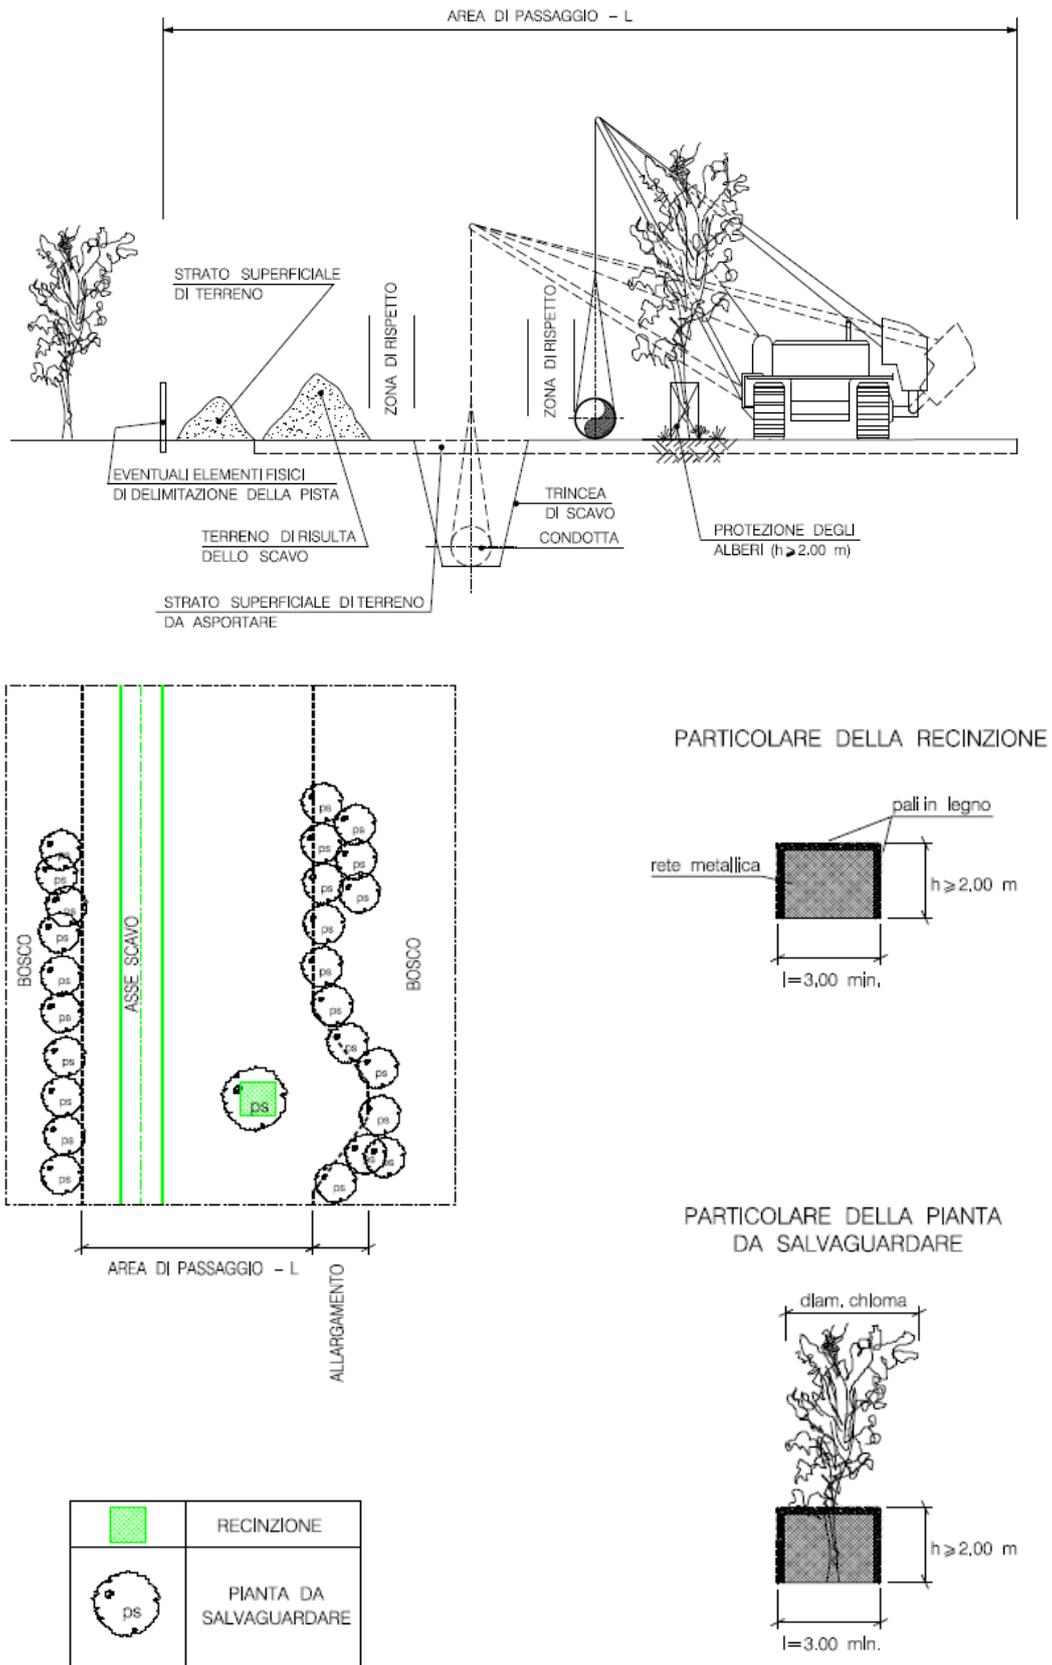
Area di passaggio ridotta con salvaguardia delle piante
